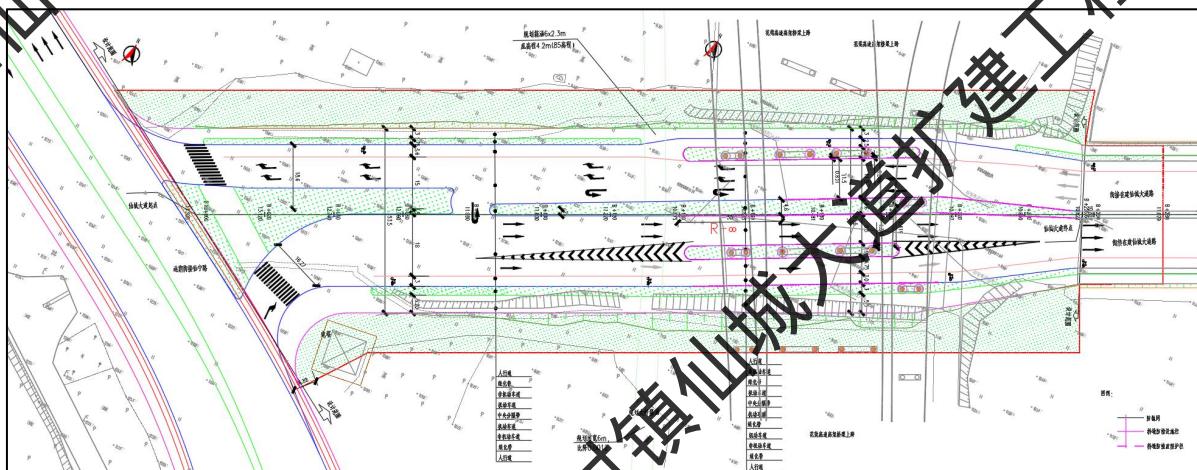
仙城大道道路平面图 (推荐平面方案)
